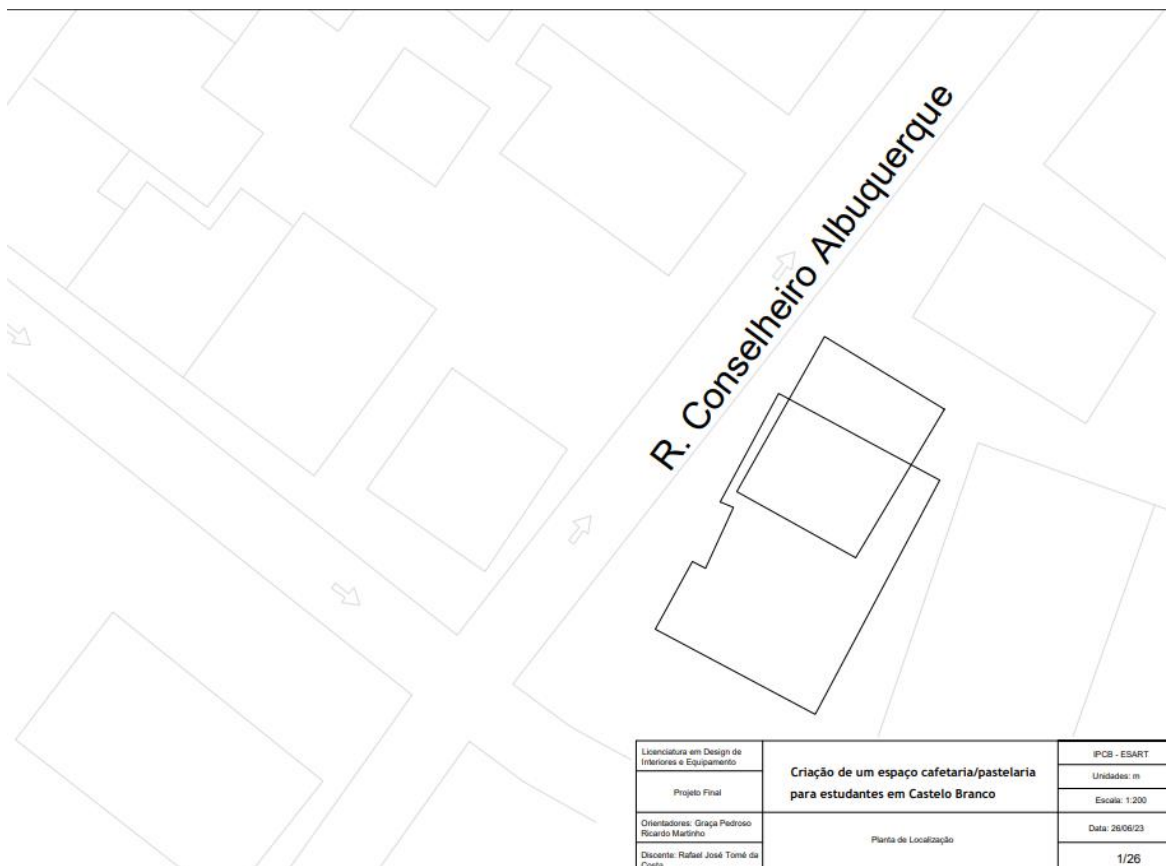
Planta de Localização. Fonte: Rafael Costa
